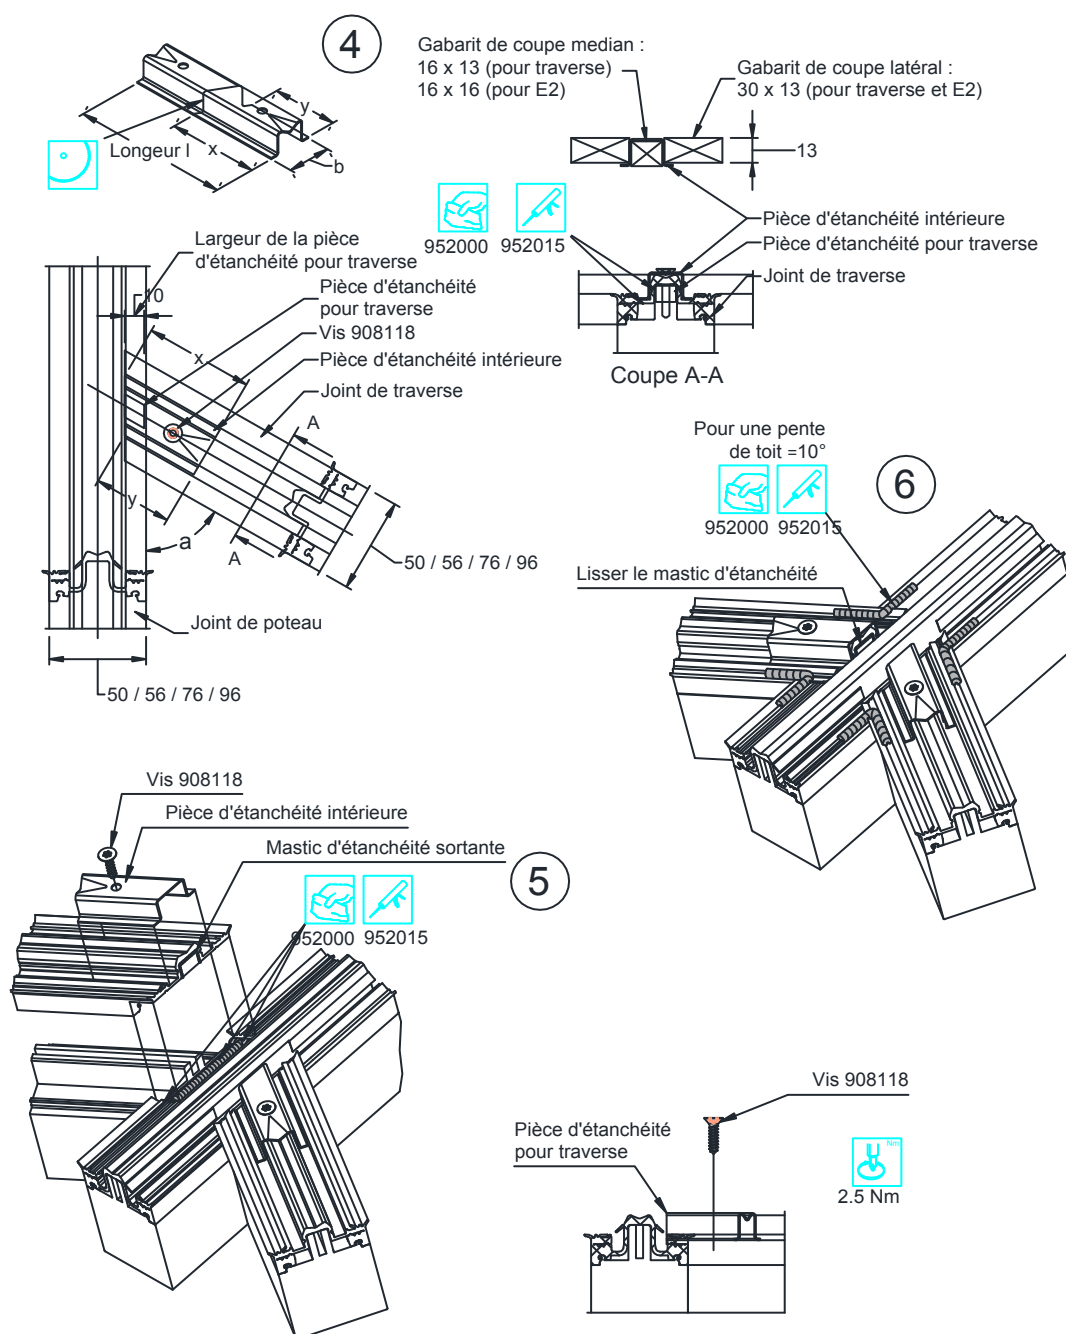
Usinage et étanchéité de joint intérieur pour les jonctions biaises : pièce d'étanchéité extérieure et mise en œuvre de la masse étanche
